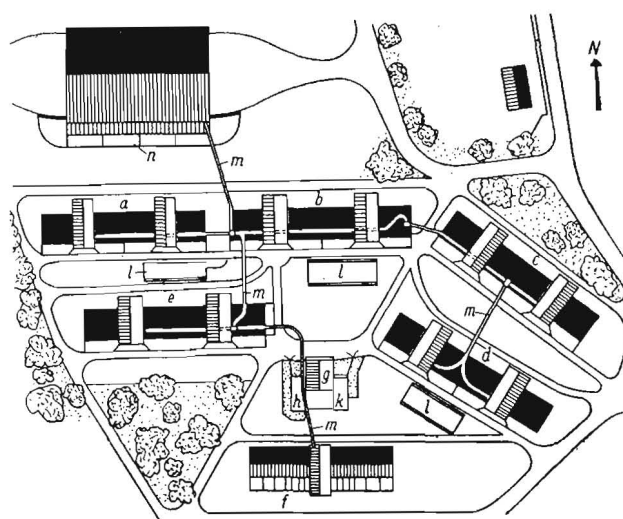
Lageplan Offenstallanlage mit Strohtransportleitung. a bis e Offenlaufställe, f Abkalbe- und Kälberstall, g Melkstandgebäude mit Speicher, h Tandem-Gruppenmelkstand, k Durchtreibmelkstand, l Durchfahrtilos aus Betonfertigteilen, m Strohtransportleitung (25 cm Ø) vom Strohlager zu allen Bergeräumen, n Jungviehstallanbau an das Kartoffellagerhaus mit Stroh- und Rübenlager (ehem. Hochfahrtscheune)
